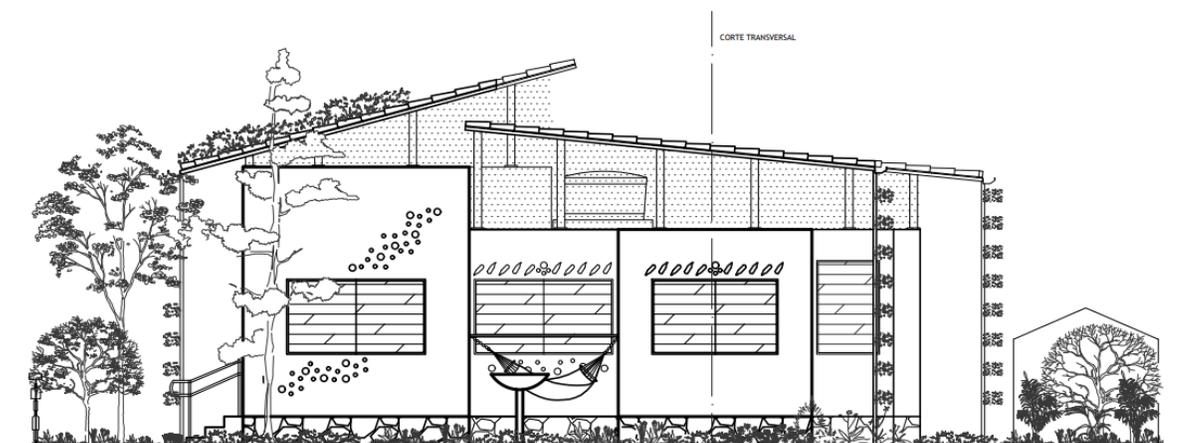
Construções com terra e com fundação de pedras elevadas
